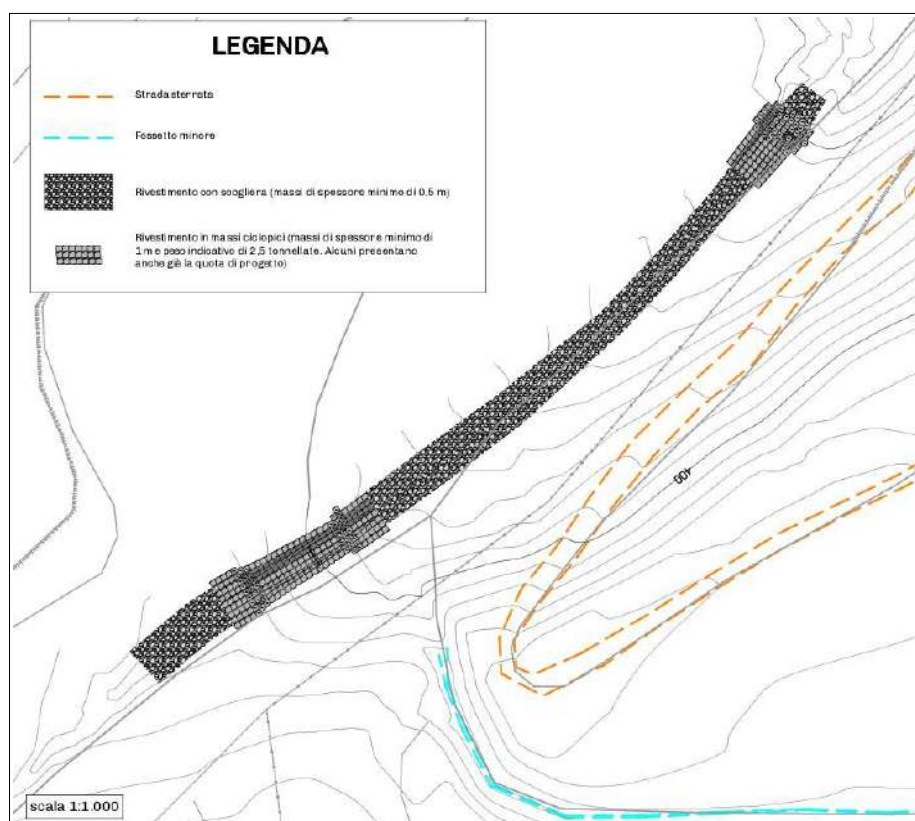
Planimetria dell'intervento di sistemazione del Fosso Cavernano estratta dal progetto di Fattibilità Tecnico Economica (TAV-017-CAV).
